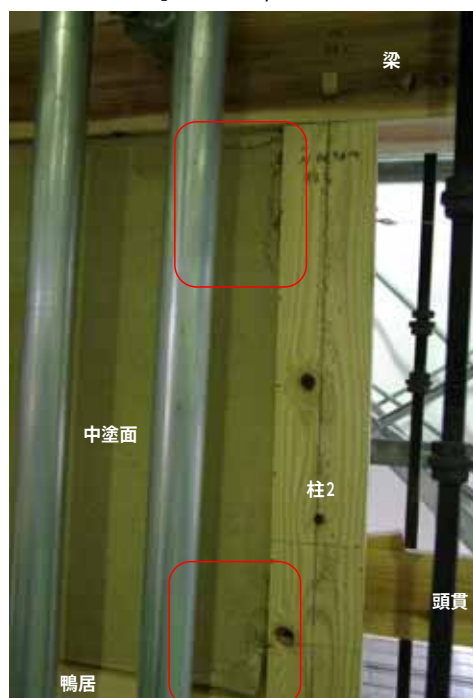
中塗側 1/30rad 隅角部のひび割れ
